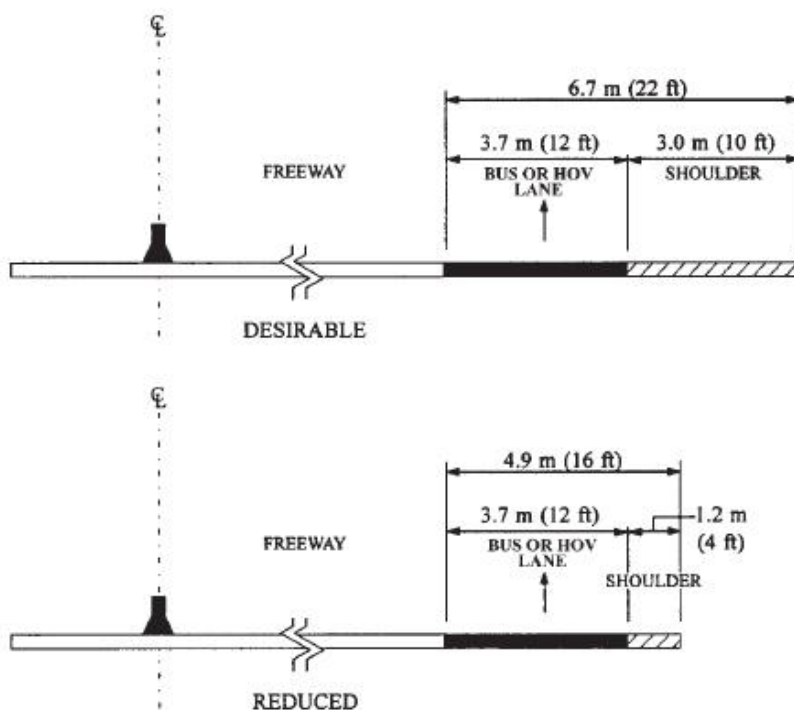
Profil en travers pour une chaussée en site propre pour autobus – voies contigües
